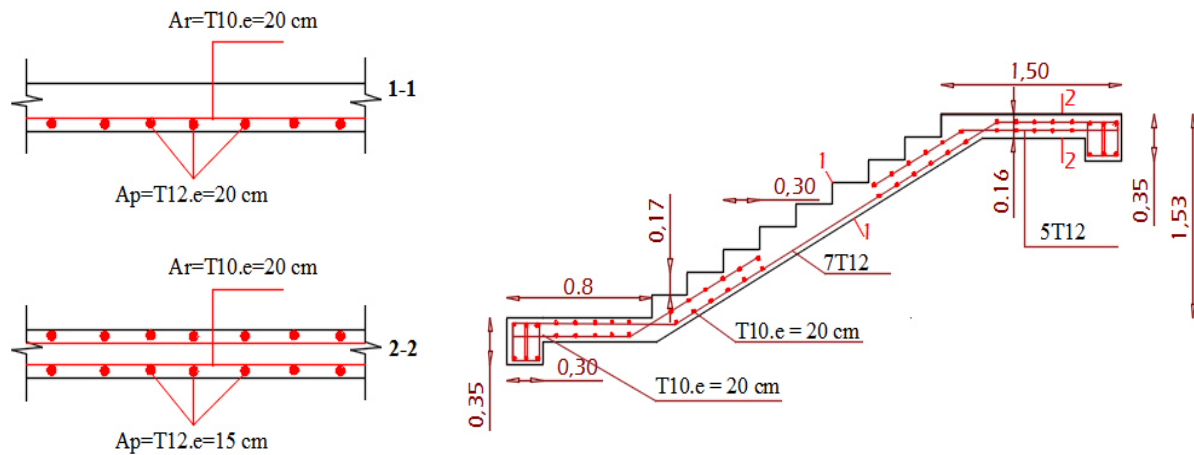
Schéma de ferrailage de l'escalier type (03)
